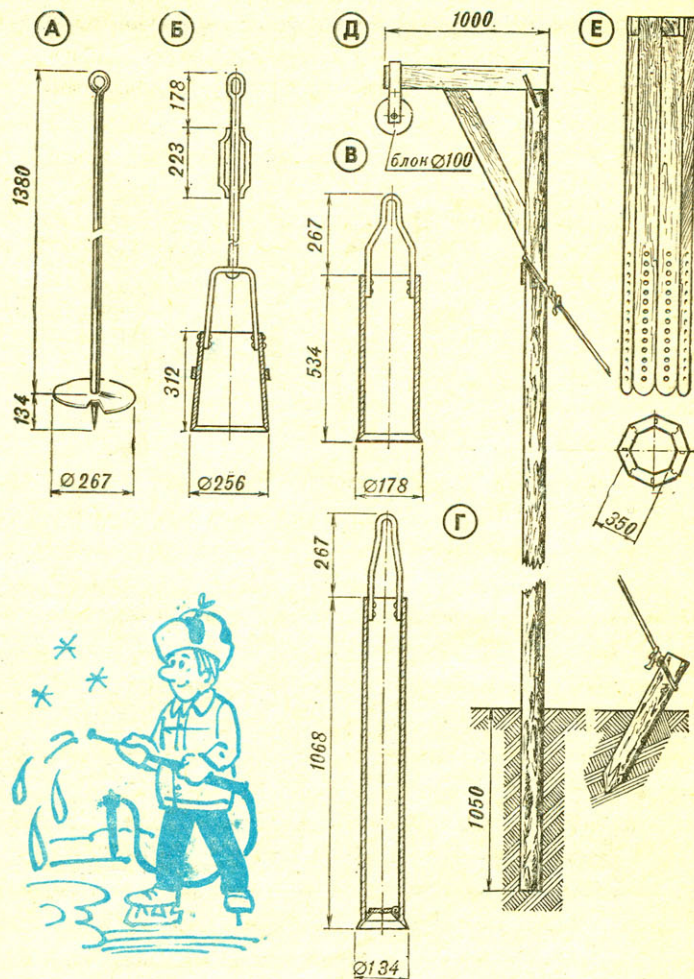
Старинный буровой снаряд Шитца: А — буров, В — конический стакан, Г — цилиндрический стакан, Г — желонка, Д — буровой станок, Е — обсадная труба из досок.
